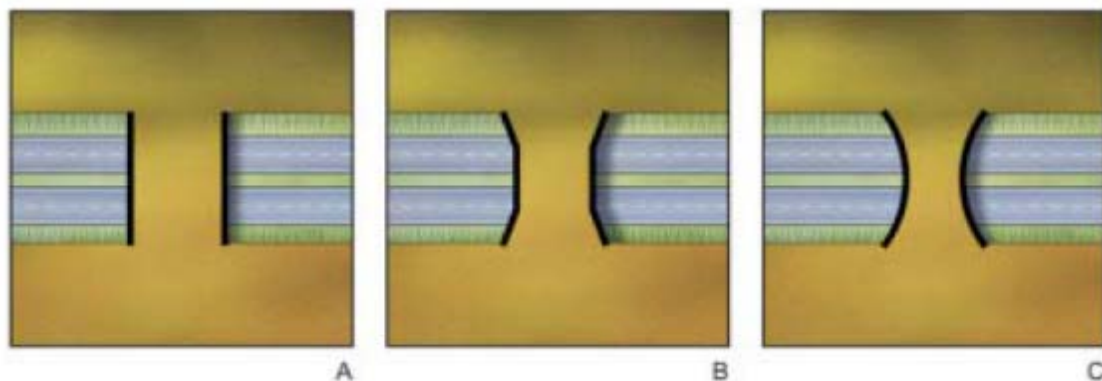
Diseños en planta de los pasos superiores; A. Planta recta. B. Planta en forma de embudo. C. Planta parabólica o en forma de diávolo. (Fuente: Documento para la reducción de la fragmentación de hábitats causada por infraestructuras de transportes).
